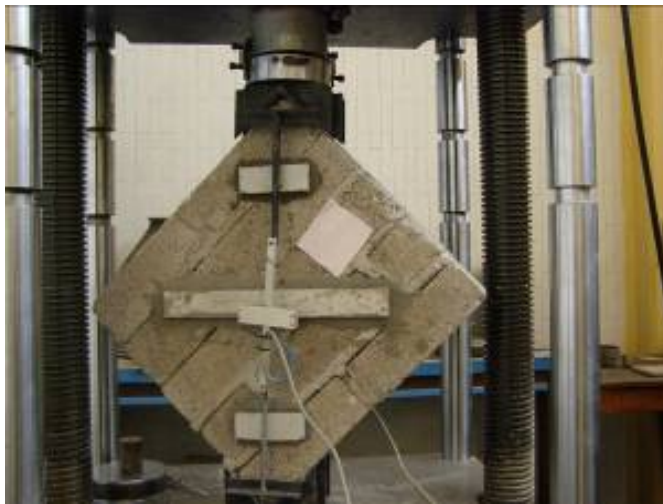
Murete reforzado con tiras de mortero geopolimérico reforzado
